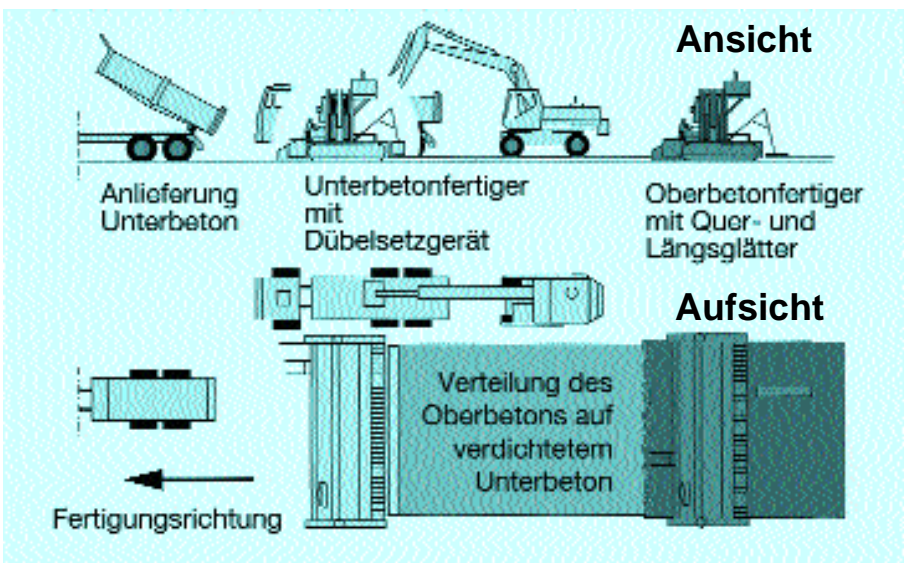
H+W-Betondecken-Einbauzug (schematisch)
